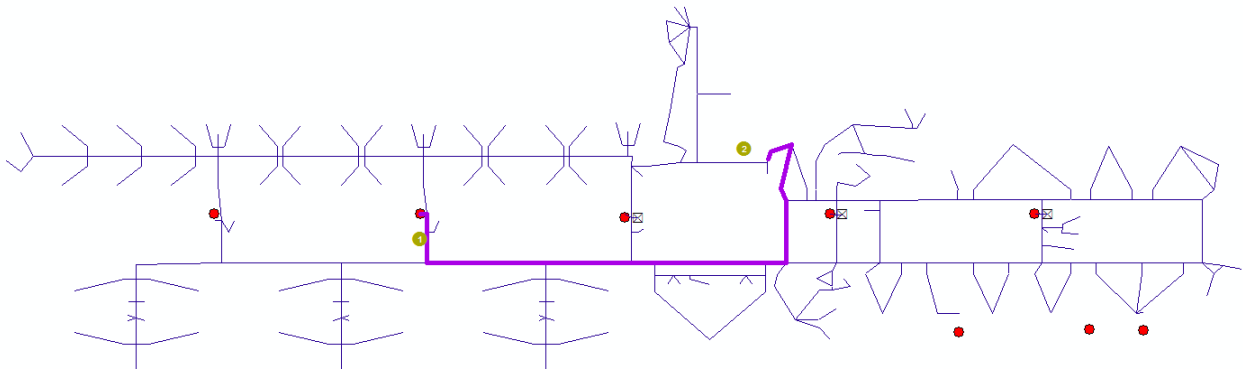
Caso práctico 1.2: Planta Primera. Longitud-Accesibilidad. Elaboración propia.
